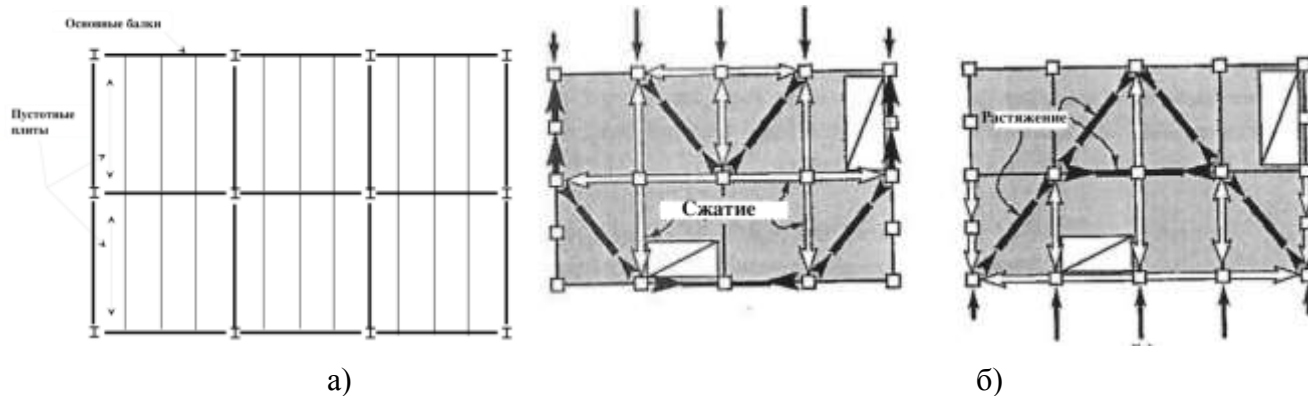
Работа жестких дисков перекрытия в составе каркаса многоэтажного здания.
